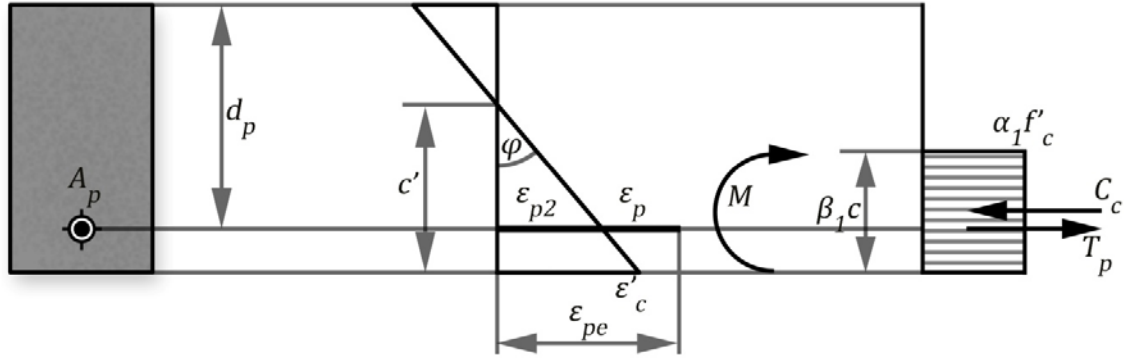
,48: Aporte del hormigón a tracción. Fibra superior traccionada
